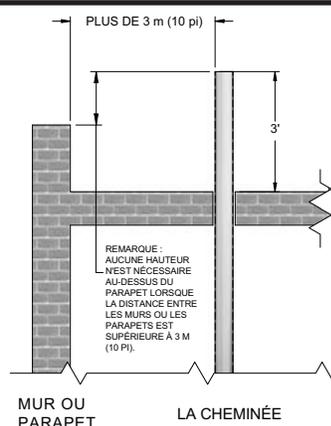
5_ Terminaison de ventilation à plus de 3 m (10 pi) d'un mur de parapet
